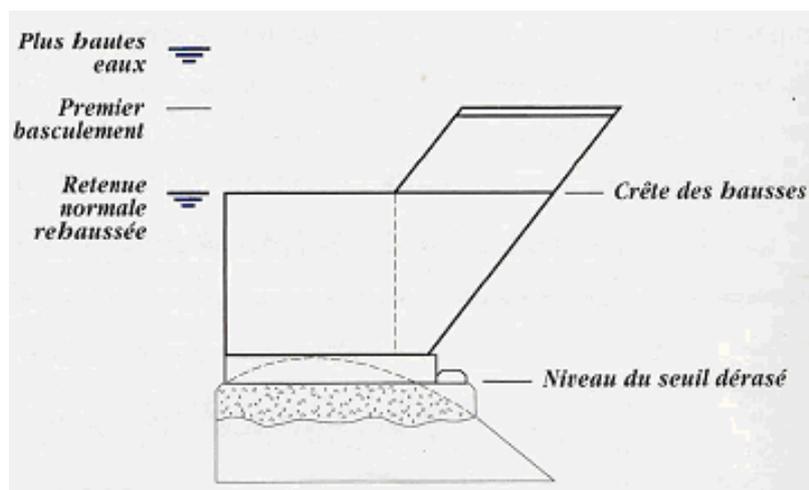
Coupe transversale d'un seuil équipé de hausse fusible
